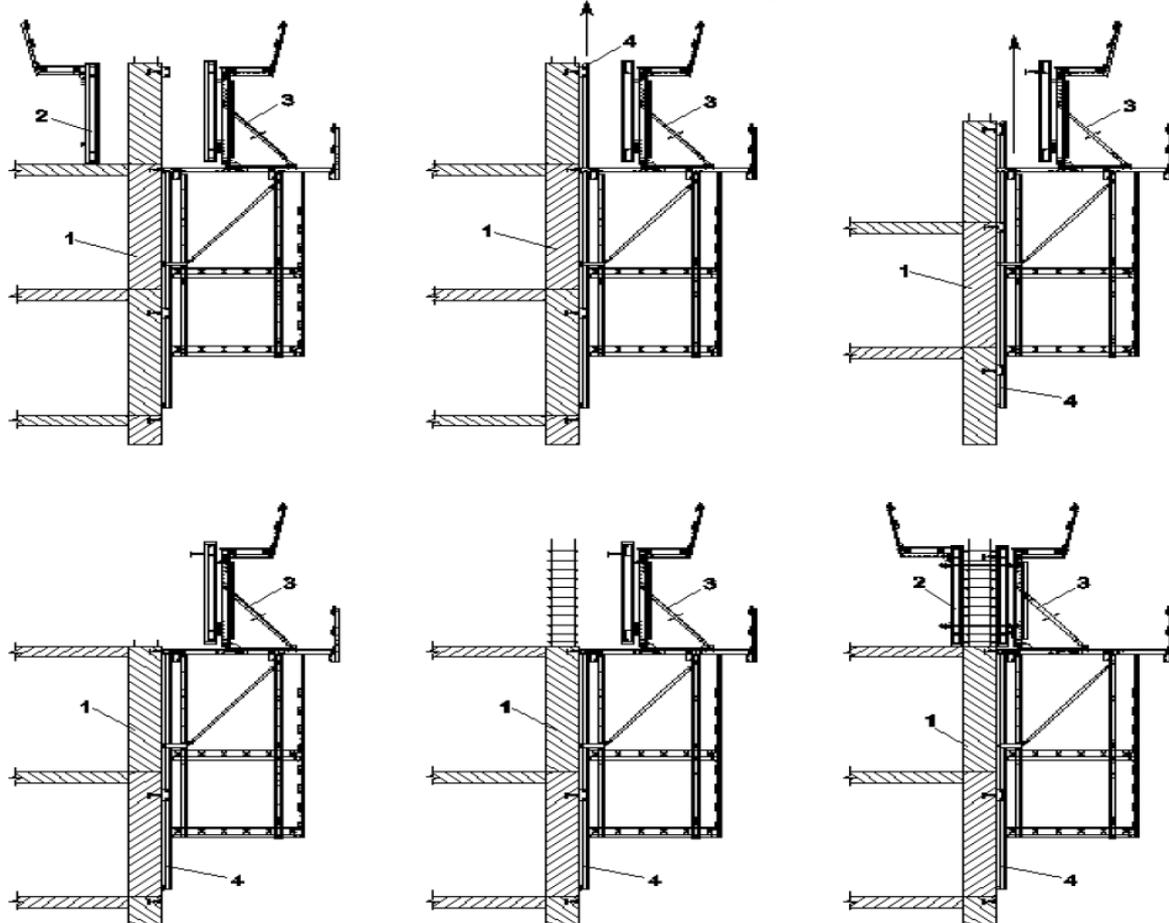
Схема перемещения подъемно-переставной опалубки по направляющим балкам: 1 – монолитная стена; 2 – внутренняя опалубочная панель; 3 – наружная опалубочная панель; 4 – направляющие балки
